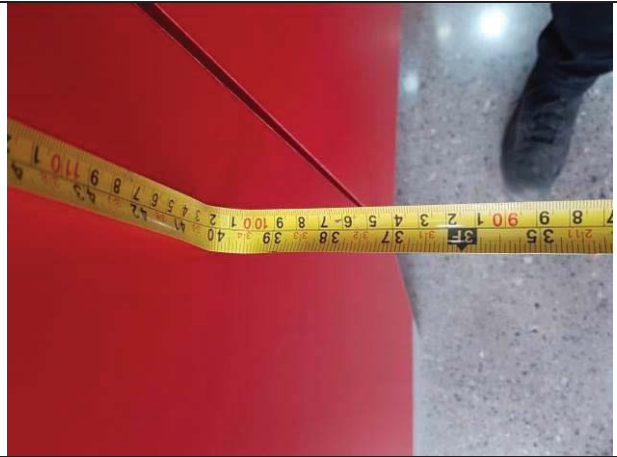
, de 11 de febrero de 2020: Acceso a recintos no informados en la planimetría del 2° nivel, del permiso de edificación N°11, de 2019
